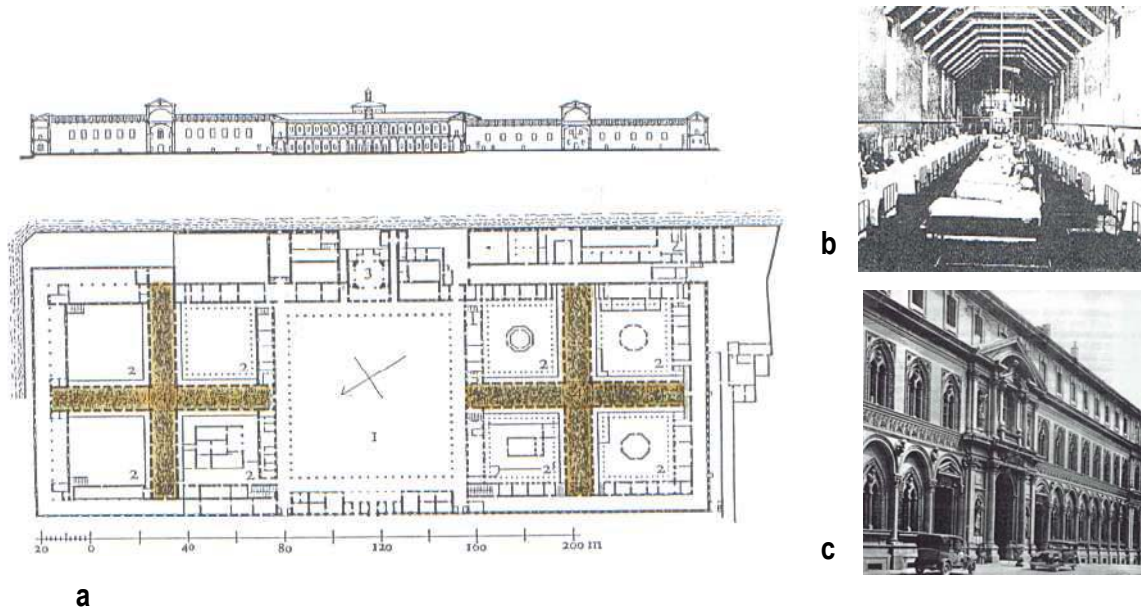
Planta baixa, corte (a), vista interna (b) e externa (c) do Ospedale Maggiore, Milão, 1450
